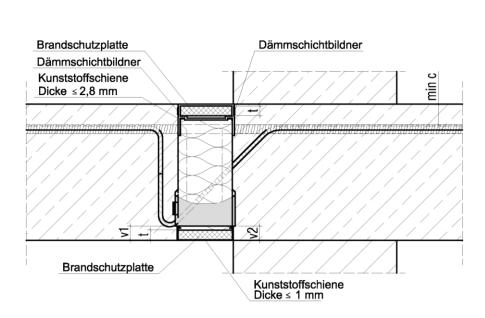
Schöck Isokorb® (REI60/ R90/ REI120) gem. Abschnitt 3.2.2
